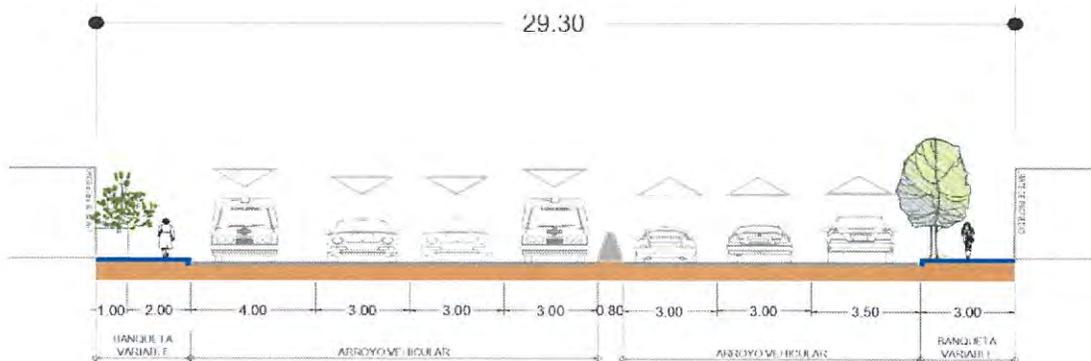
Sección transversal Calz. Chivatito. Fuente: IDOM
